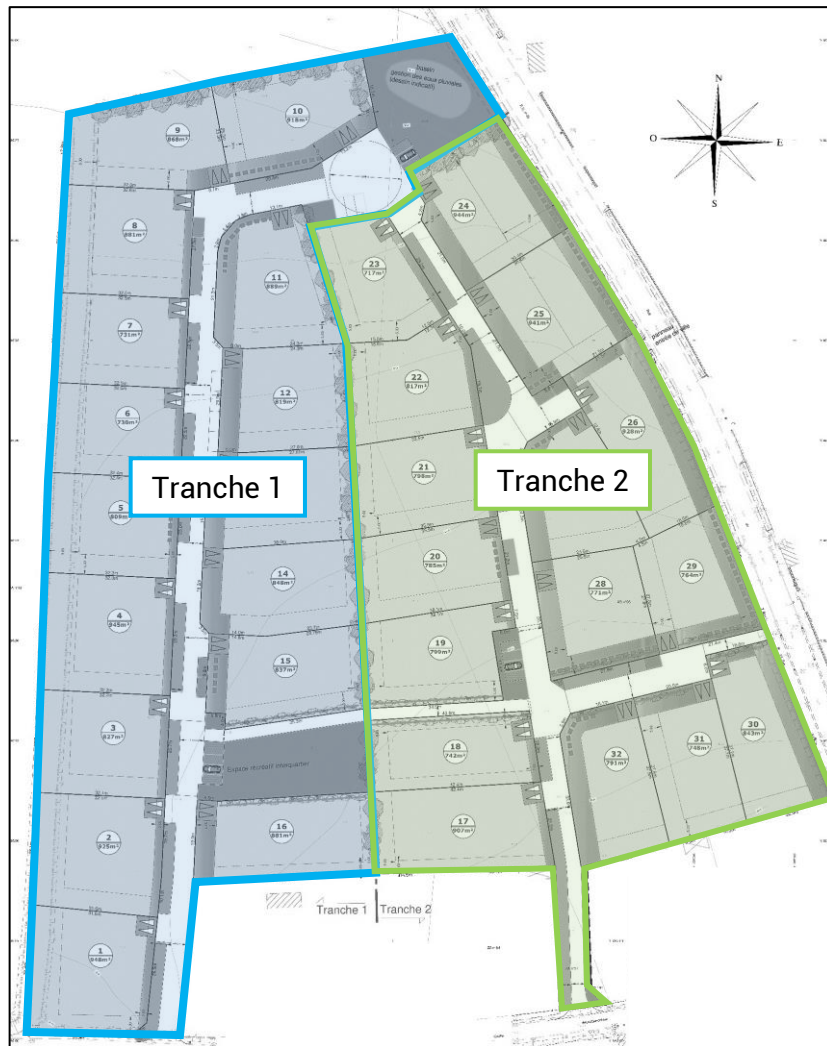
Tranches prévisionnelles du projet (Source : TECAM)
